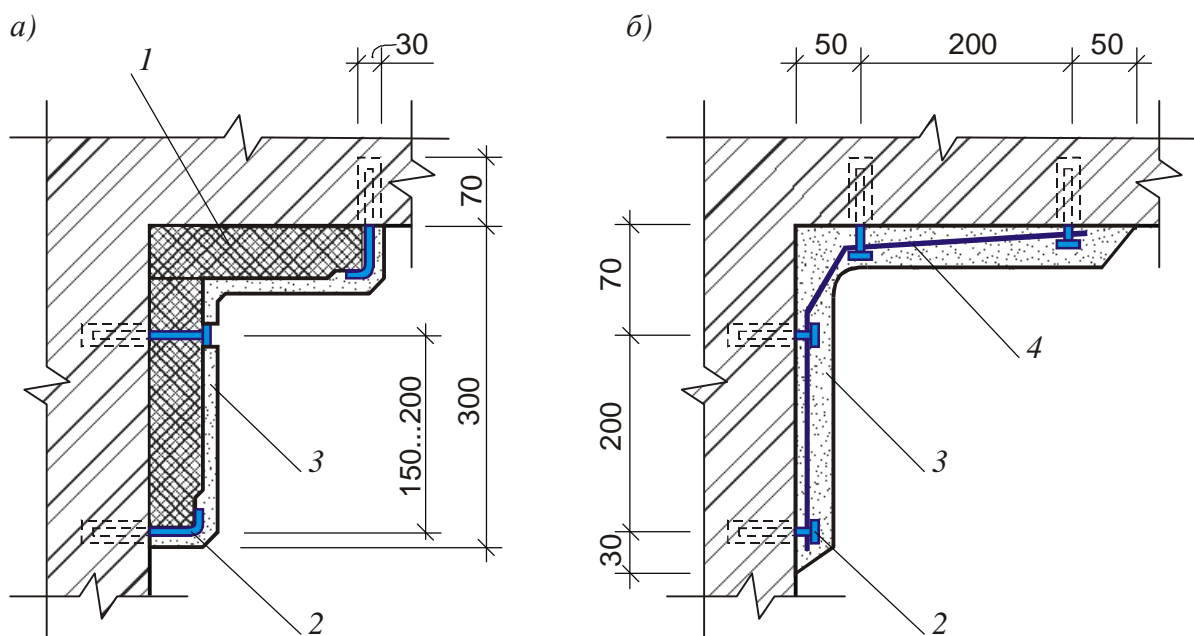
Утепление внутренних углов зданий с использованием утеплителя: а – плитного; б – монолитного; 1 – утеплитель; 2 – анкер; 3 – штукатурка; 4 – арматурная сетка
